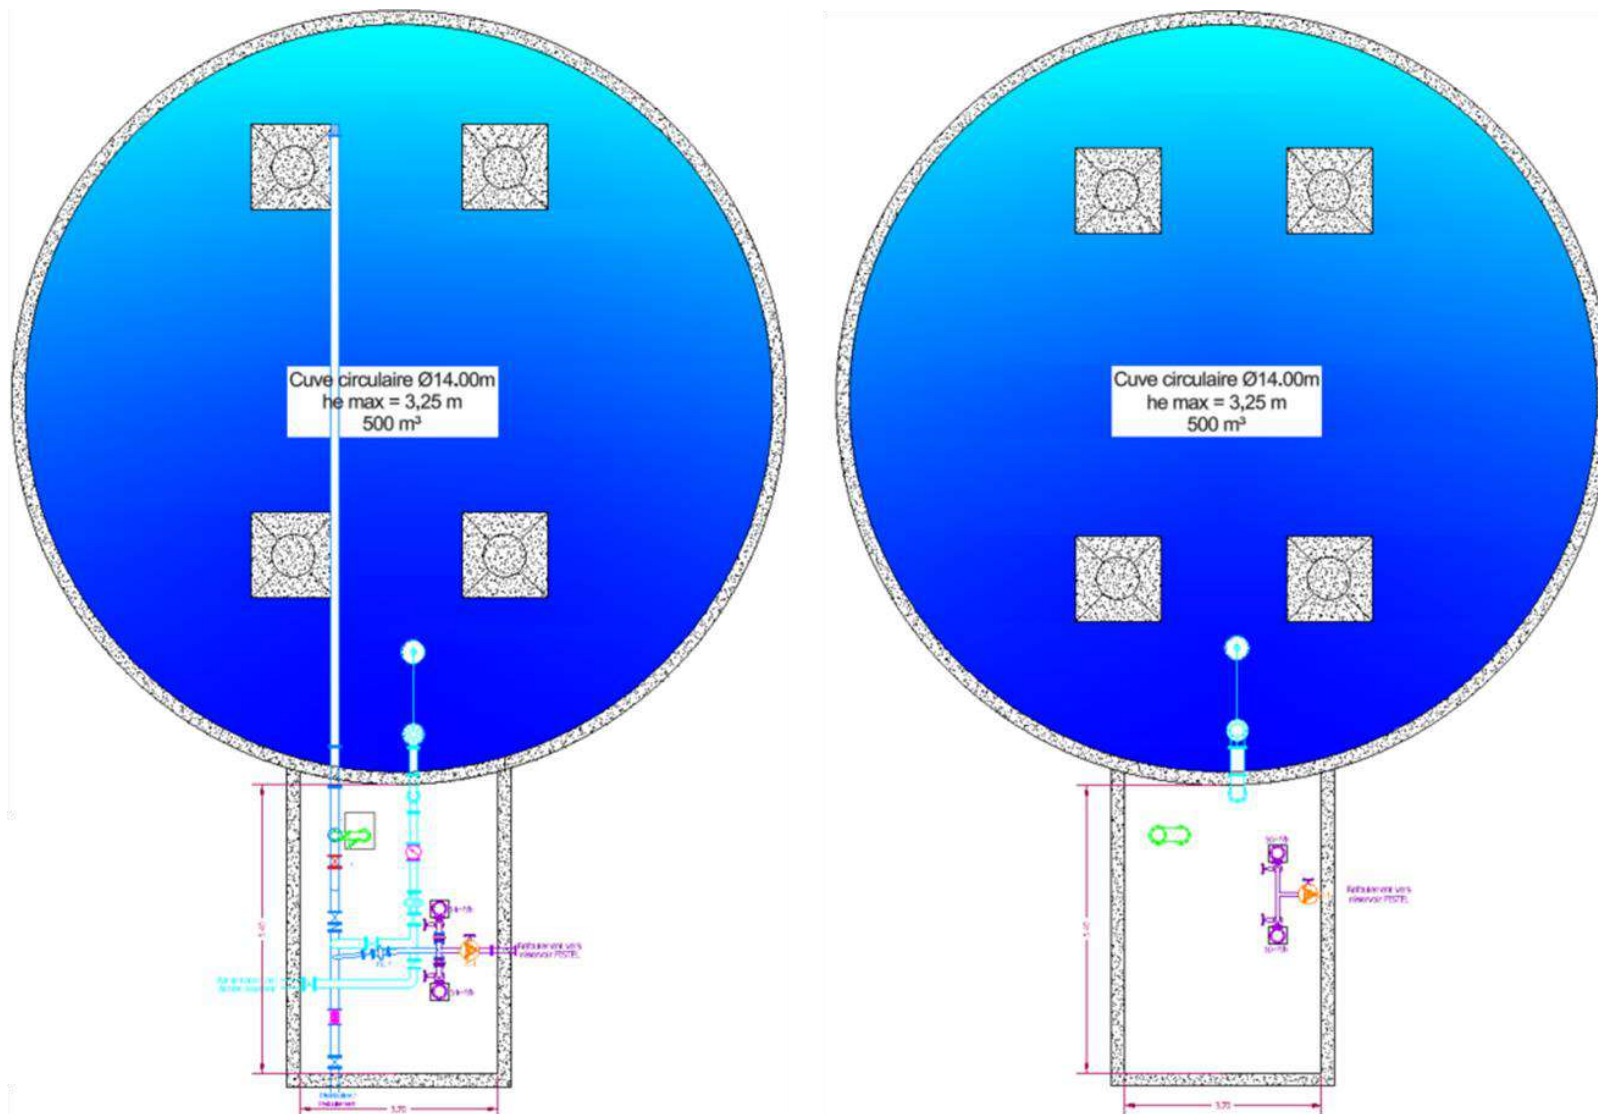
Plans de masse du projet – Sous-sol et rez-de chaussée
